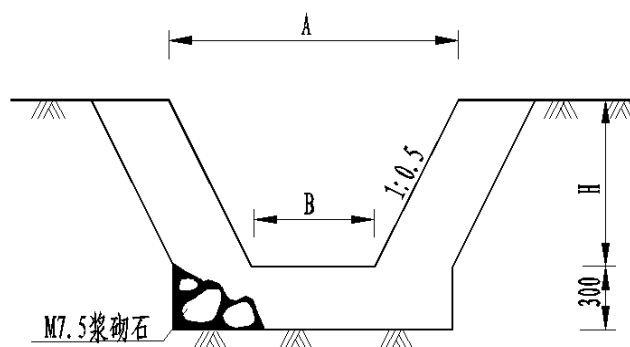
弃渣场截水沟设计断面示意图 (单位:mm)
